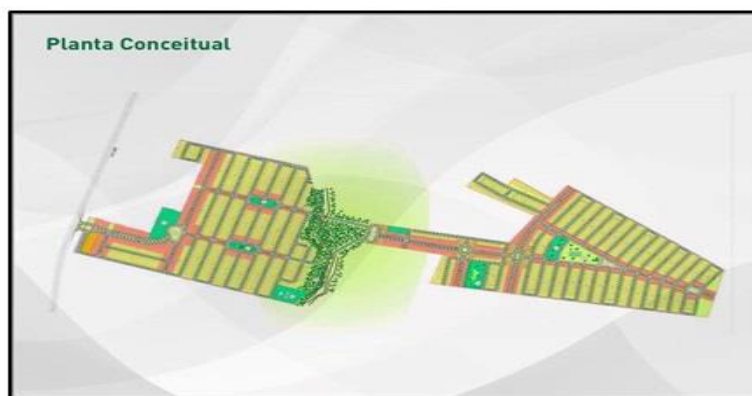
Planta Conceitual do Loteamento Terra Nova Bosque.
